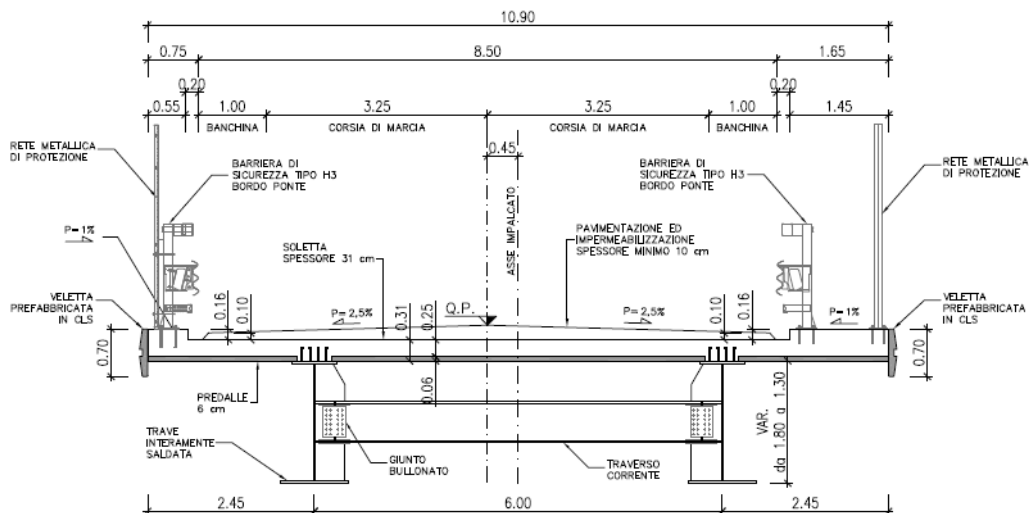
Sezione trasversale impalcato per cavalcavia B=10.90m
